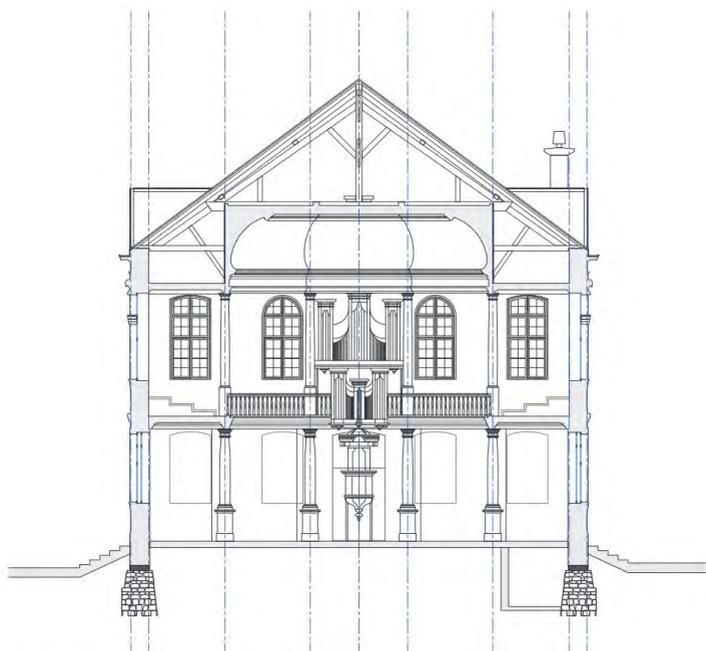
Coupe transversale Lac, état existant. Atelier Féroé 2016.
